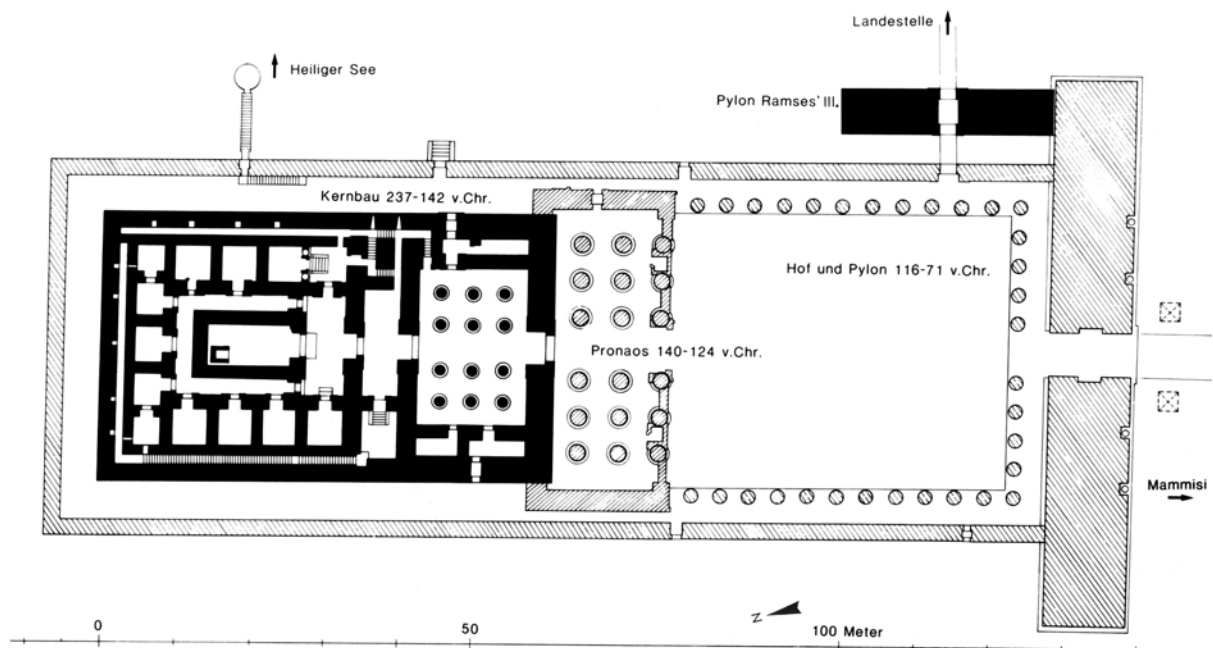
Grundriss Horus-Tempel/Edfu
